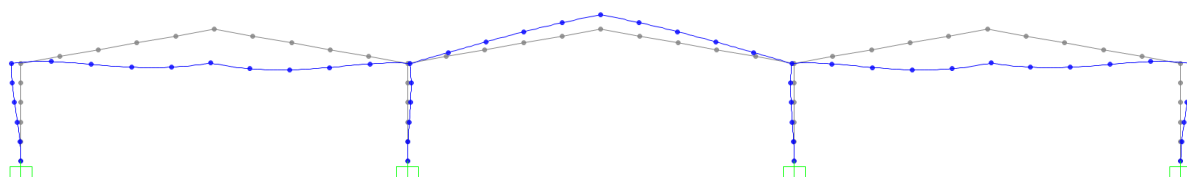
Configuração deformada devido ao carregamento vertical – W (Pórtico PE2)
